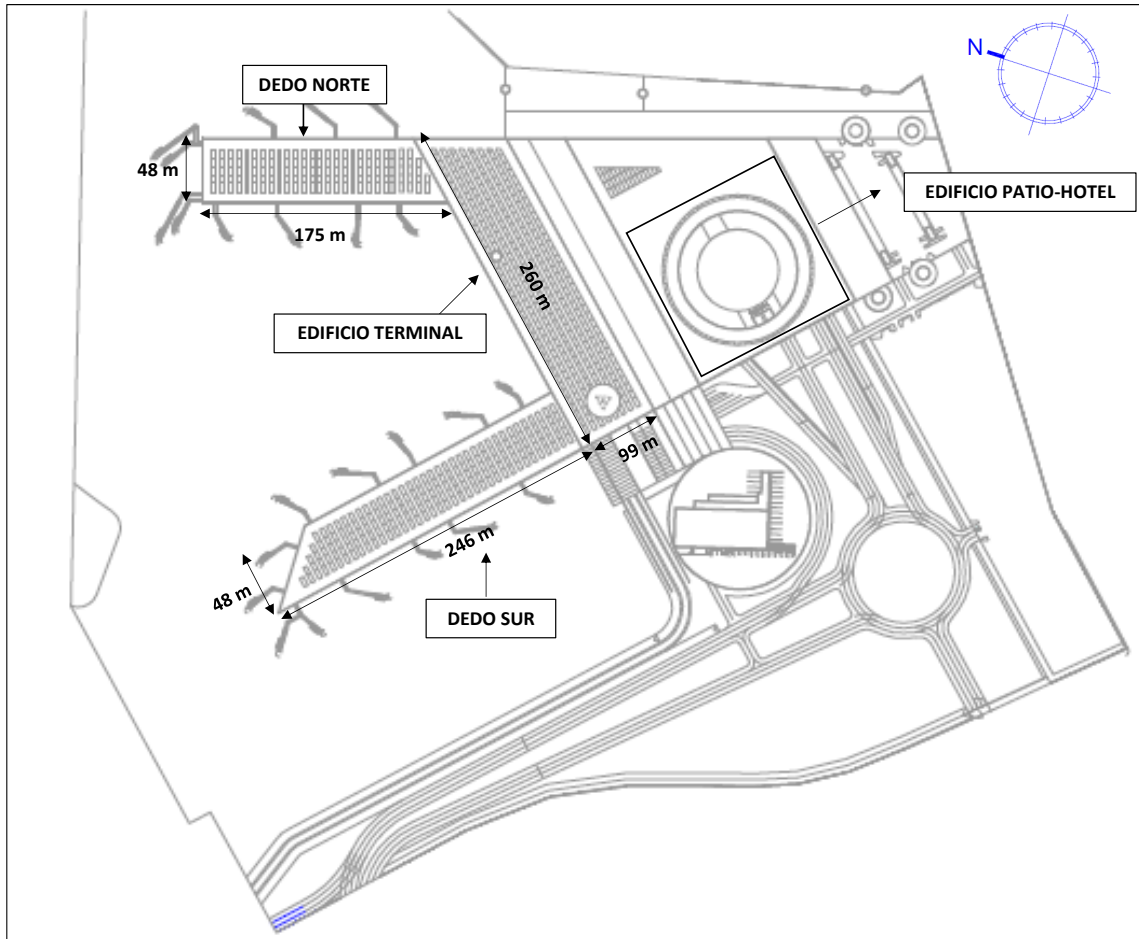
2. Localización en planta de los edificios principales de la Terminal 2 (modificado ASA, 2005)
